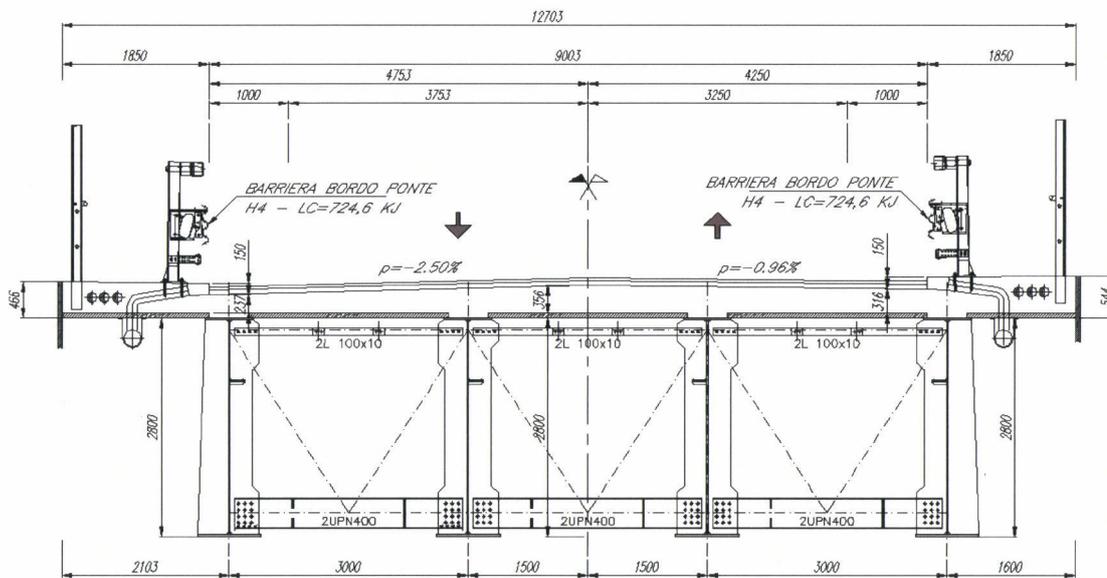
Campata di scavalco a sezione mista - Sezione.
